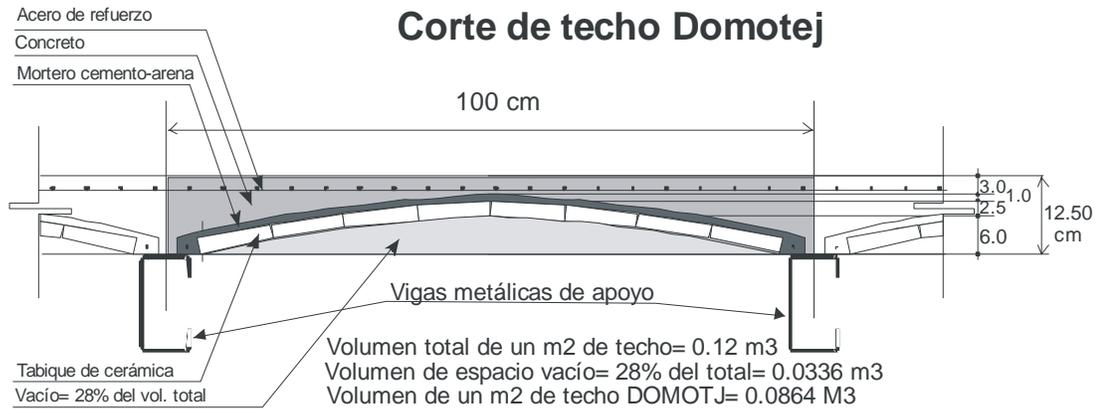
Corte de un metro cuadrado de techo DOMOTEJ, con el cálculo de volumen de concreto utilizado en un metro cuadrado
